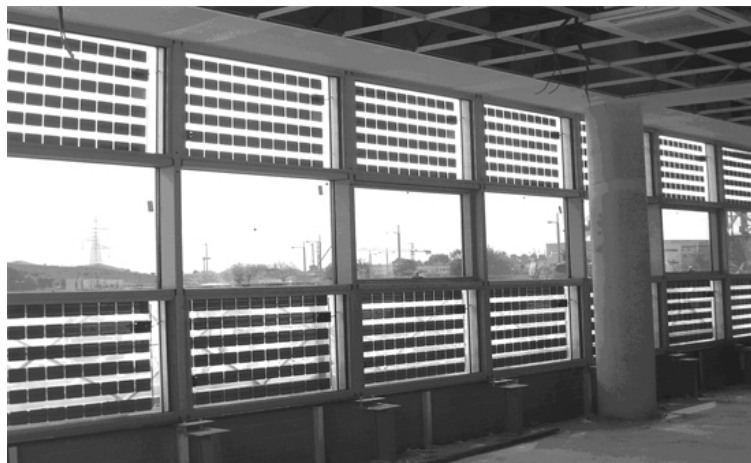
fachada suroeste durante la construcción. -Montaje de paneles cerámicos
